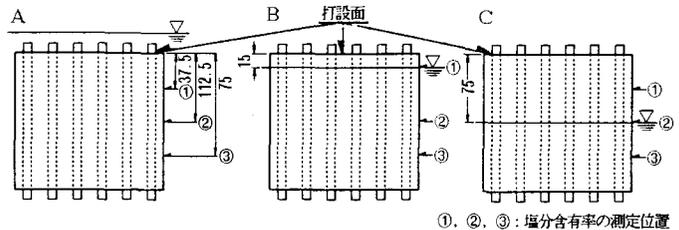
供試体の浸漬状態および塩分含有率の測定位置 単位（mm）
